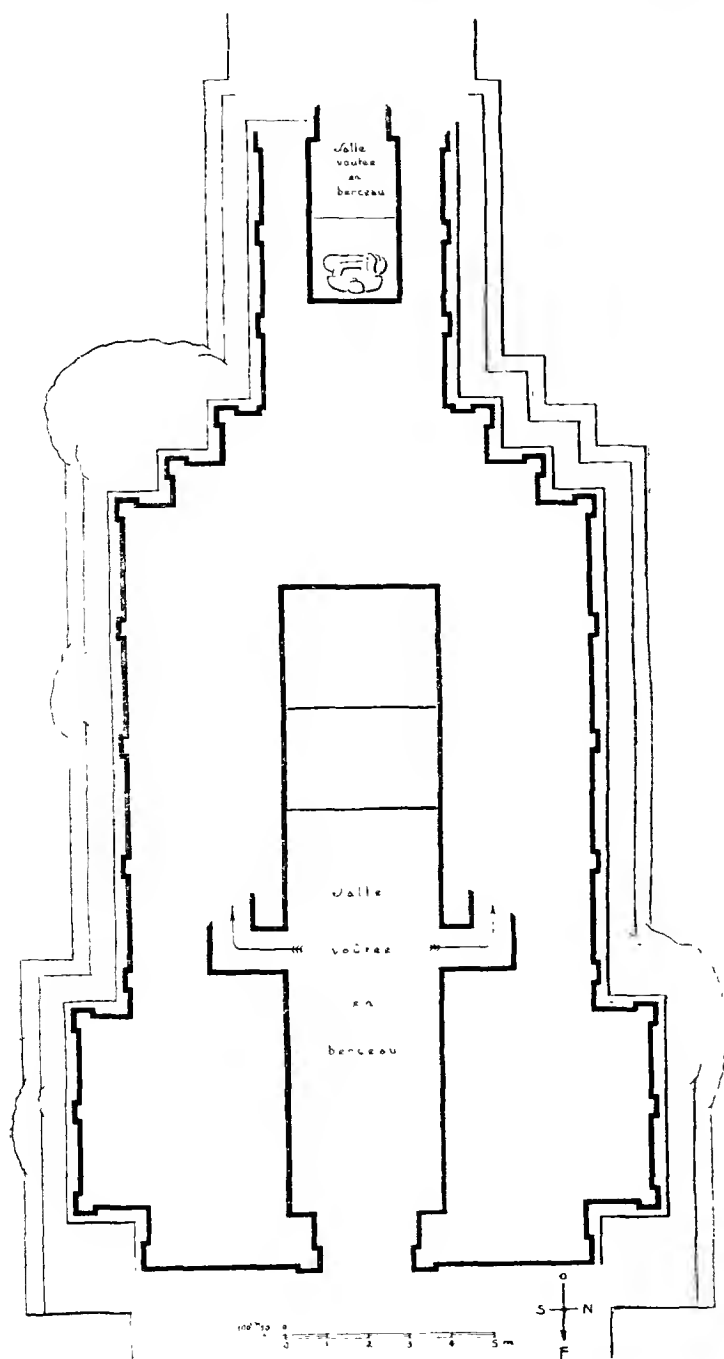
C'ENG MÀI. Wát Cết Yôt. Plan du rez-de-chaussée.
